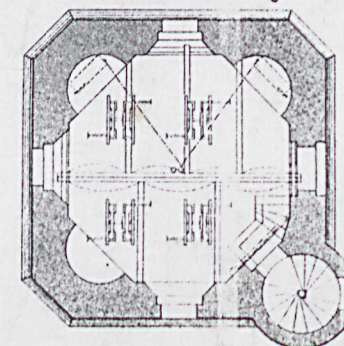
Grundriss des Wasserturms im Erdgeschoss.
